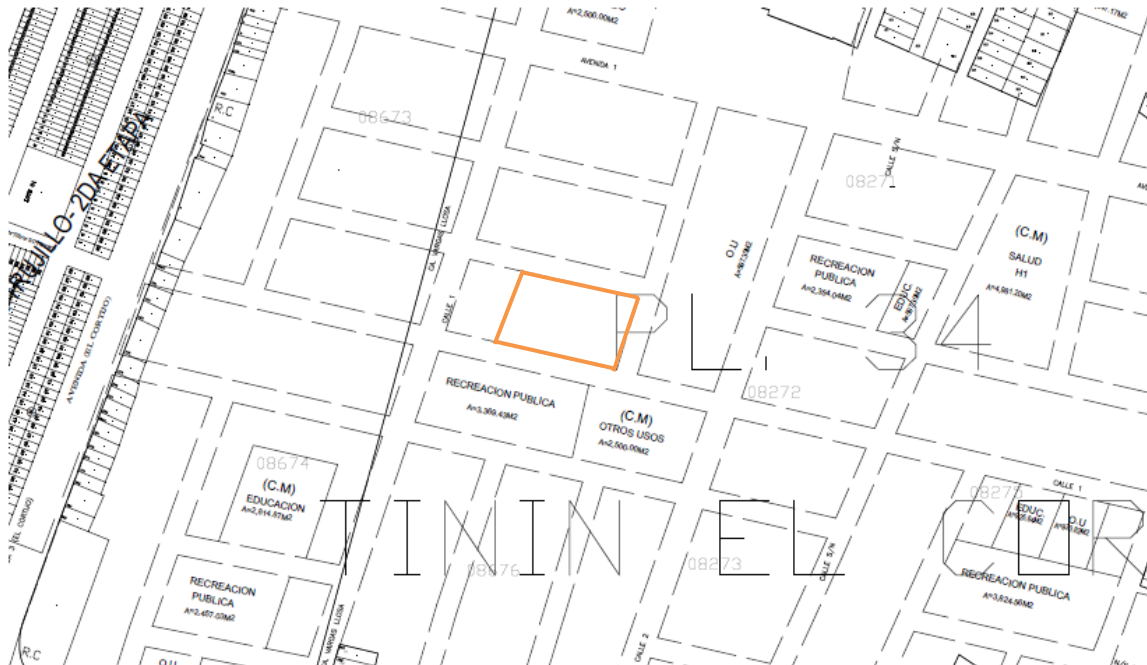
Plano de terreno N° 3. Fuente: Elaboración Propia
